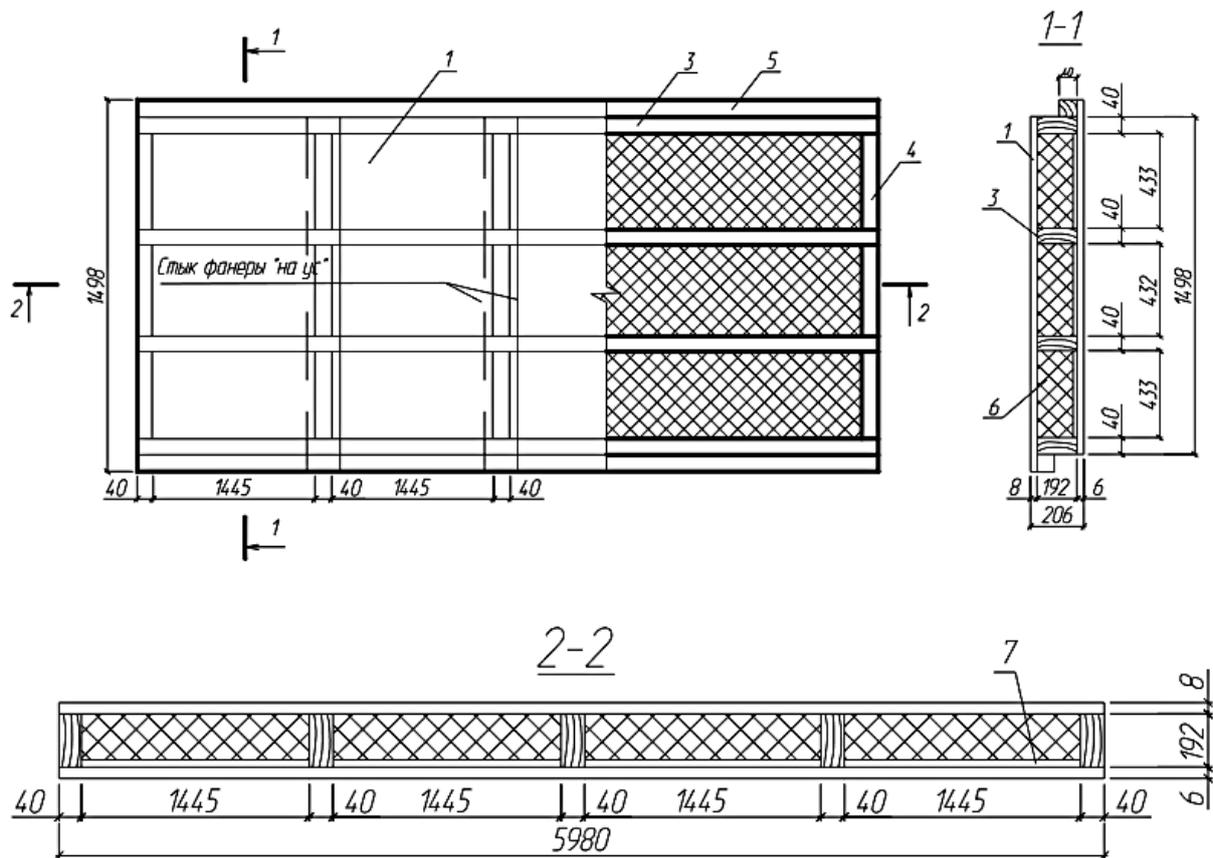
Клефанерная панель покрытия: 1 – верхняя обшивка; 2 – нижняя обшивка; 3 – продольные ребра; 4 – поперечные ребра; 5 – соединительные бруски; 6 – утеплитель; 7 – пароизоляция
